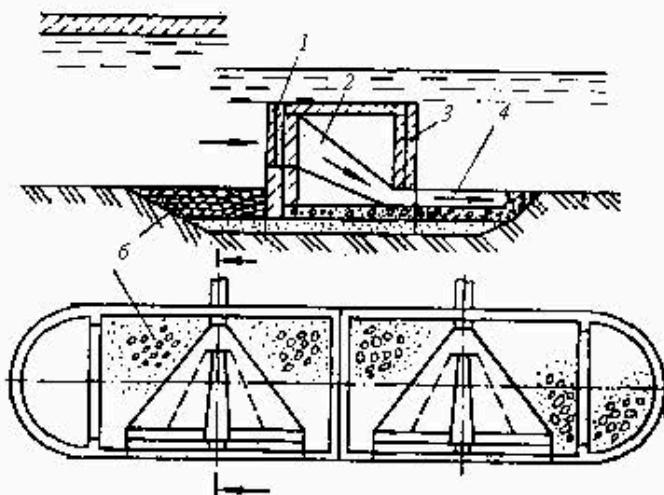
Железобетонный растребный защищенный оголовок с боковым приемом воды:
